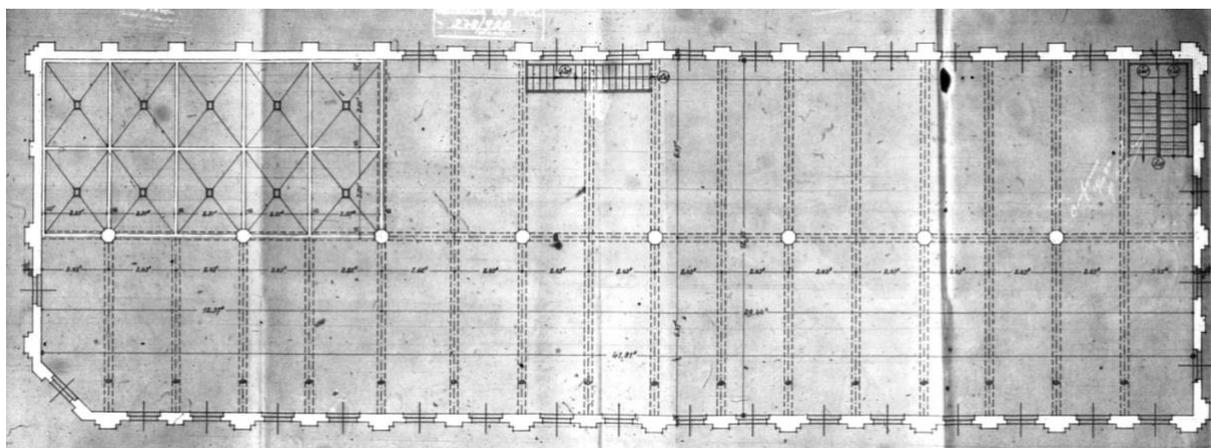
Planta baixa original do pavimento tipo, 1920. Fonte: Arquivo Municipal de Porto Alegre, 1920.
